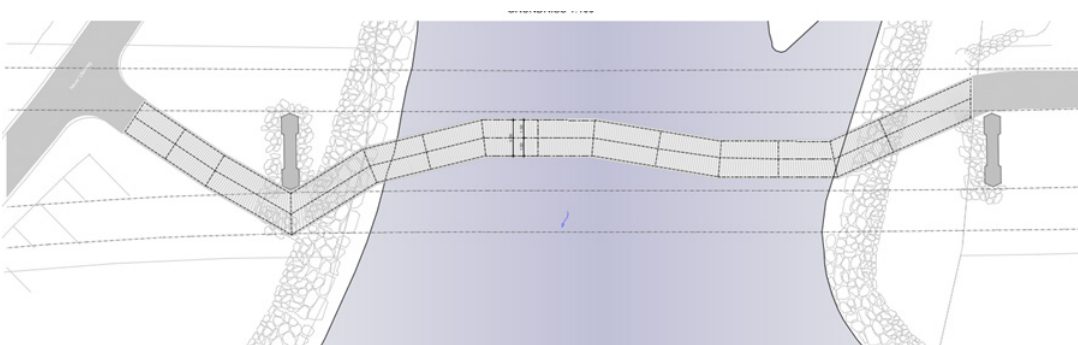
Grundriss Fussgängersteg Wattwil
